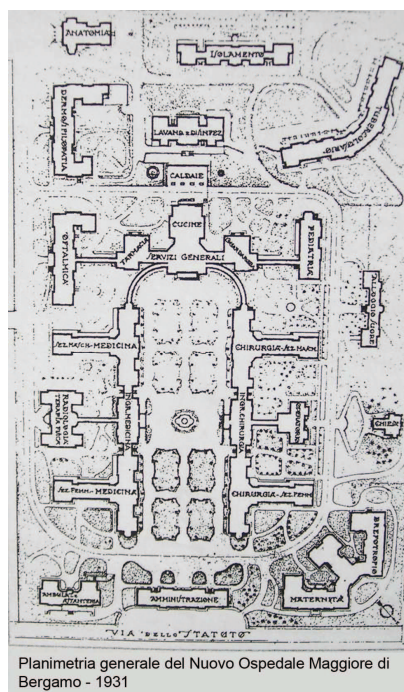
Planimetria generale del Nuovo Ospedale Maggiore di Bergamo
